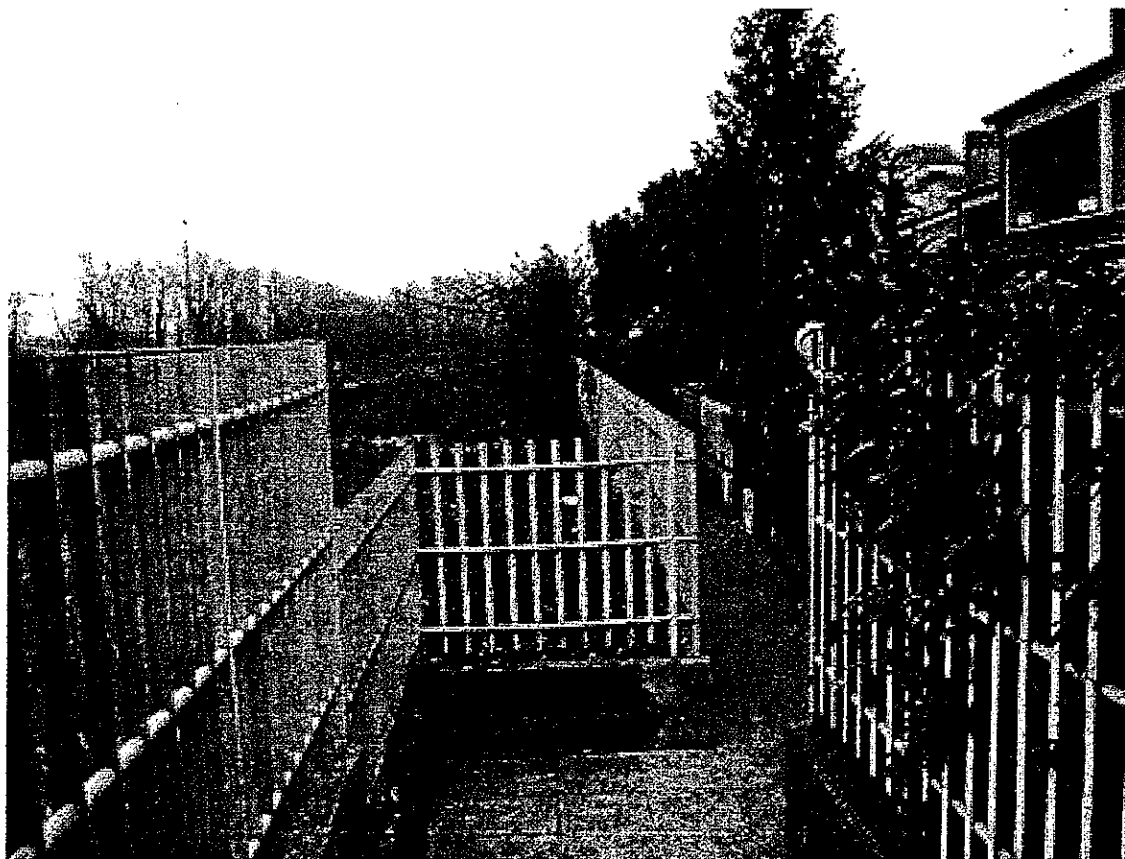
Il vialetto d'accesso alle villette dalla n. 1 alla n. 18.
